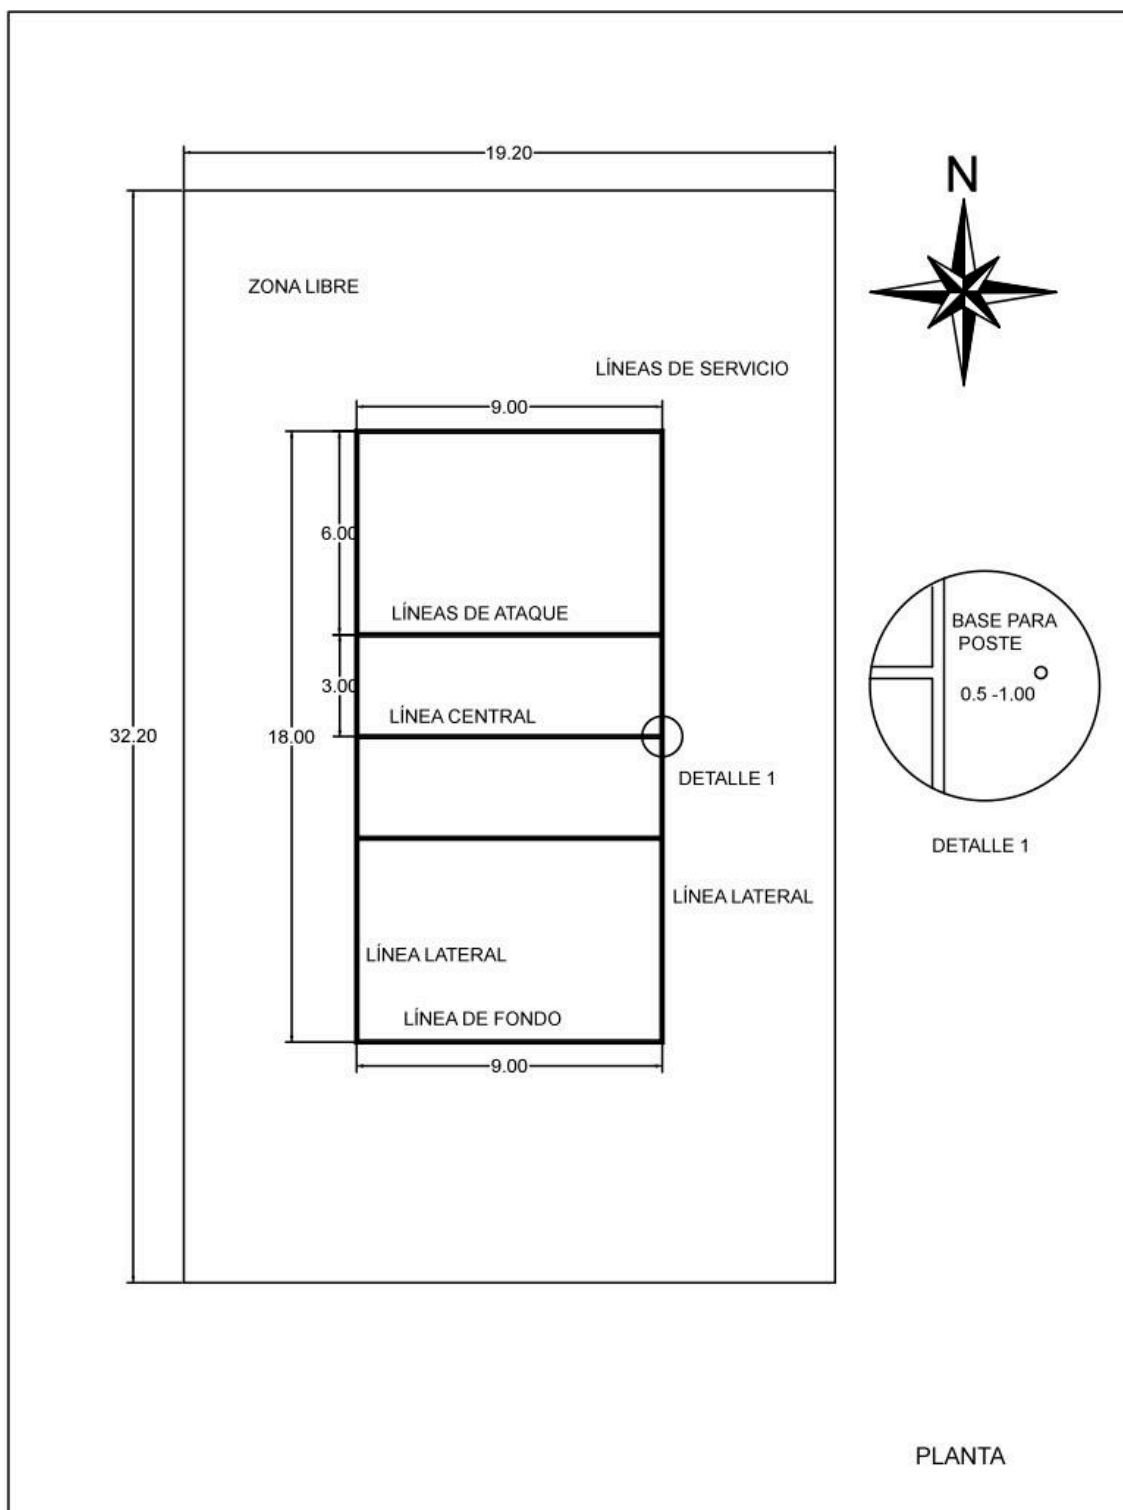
Planta de una cancha de voleibol. Fuente: Elaboración propia
